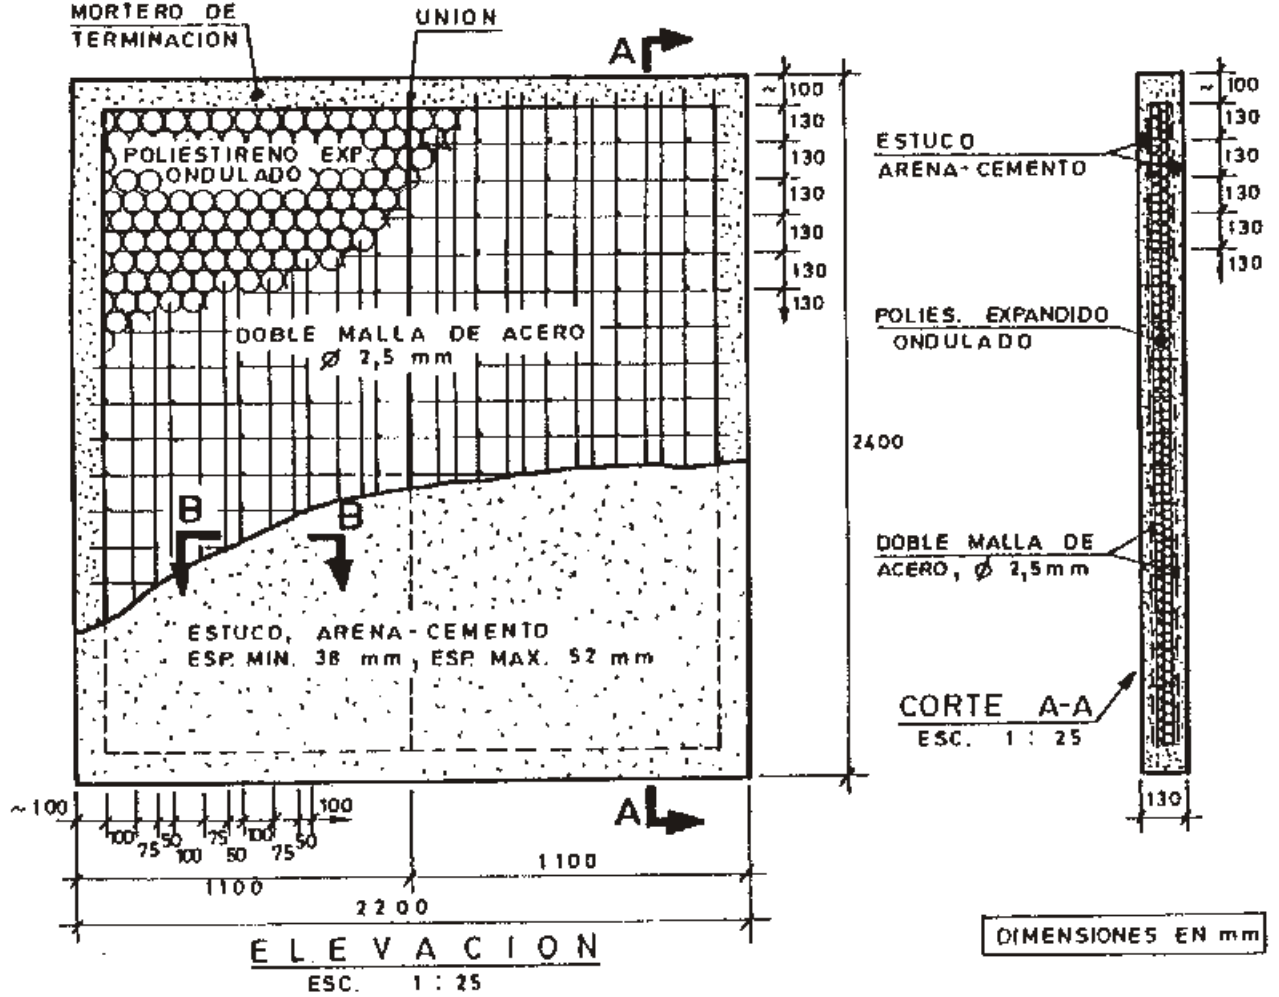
ELEVACION, CORTE Y DETALLE DEL ELEMENTO.
